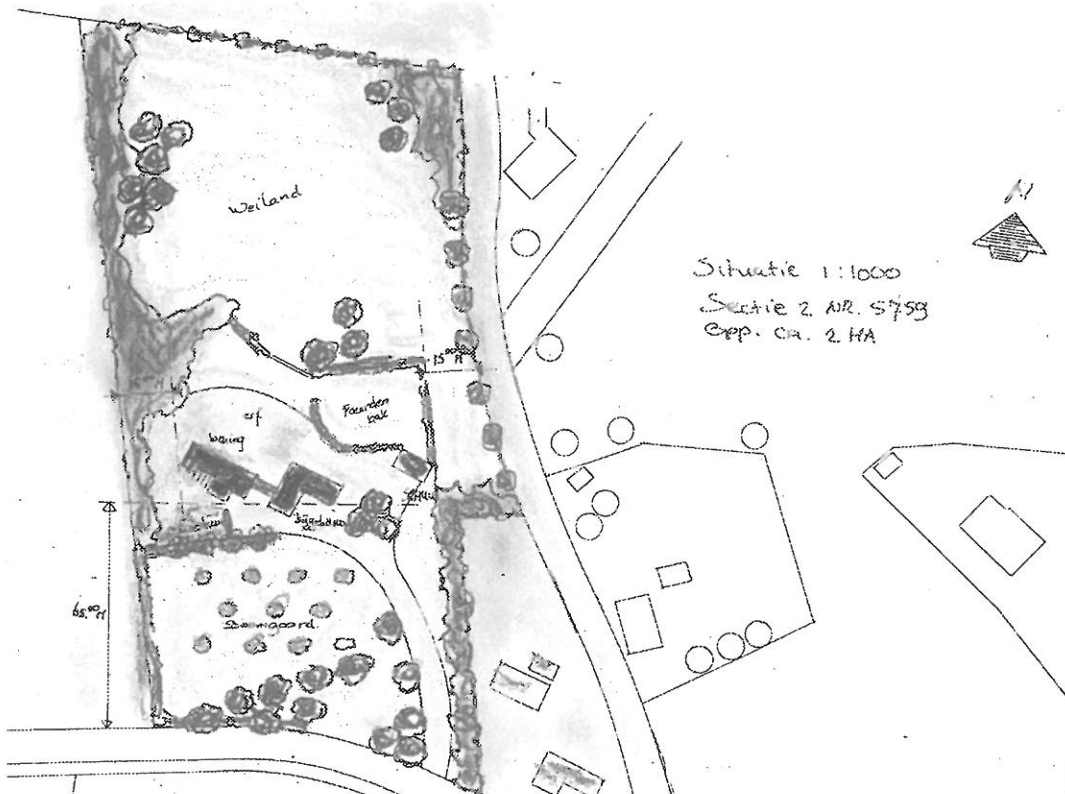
Erfinrichtingsplan uit landschapsplan
